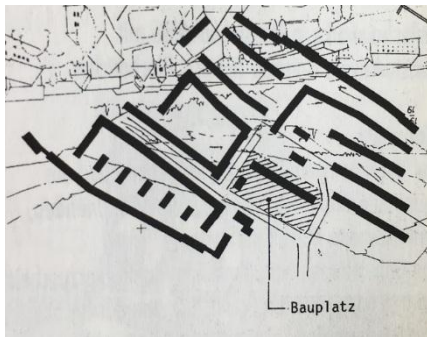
Lageplan Wohnbau Eisenerz    Abbildung 88 Fassade Wohnbau Eisenerz
